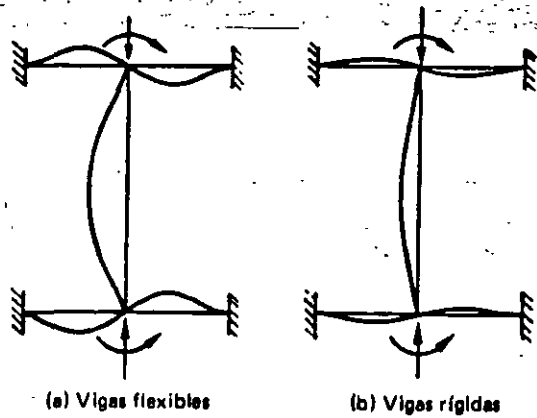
Efecto de la rigidez flexionante de las vigas que restringen a una columna.
